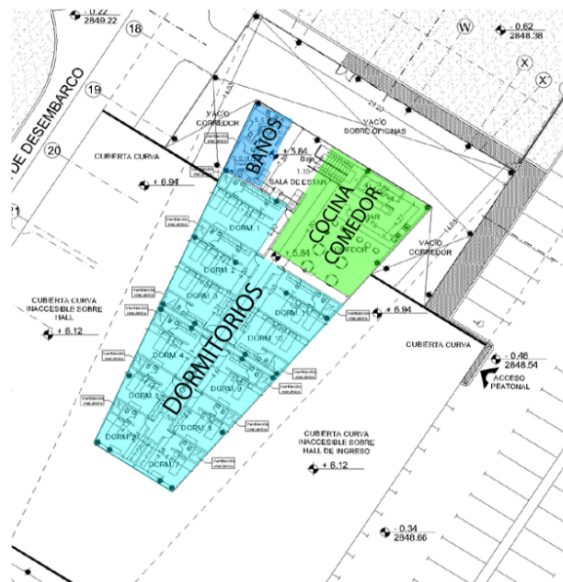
Zonificación de planta alta, segundo edificio del terminal sur de Ambato.
